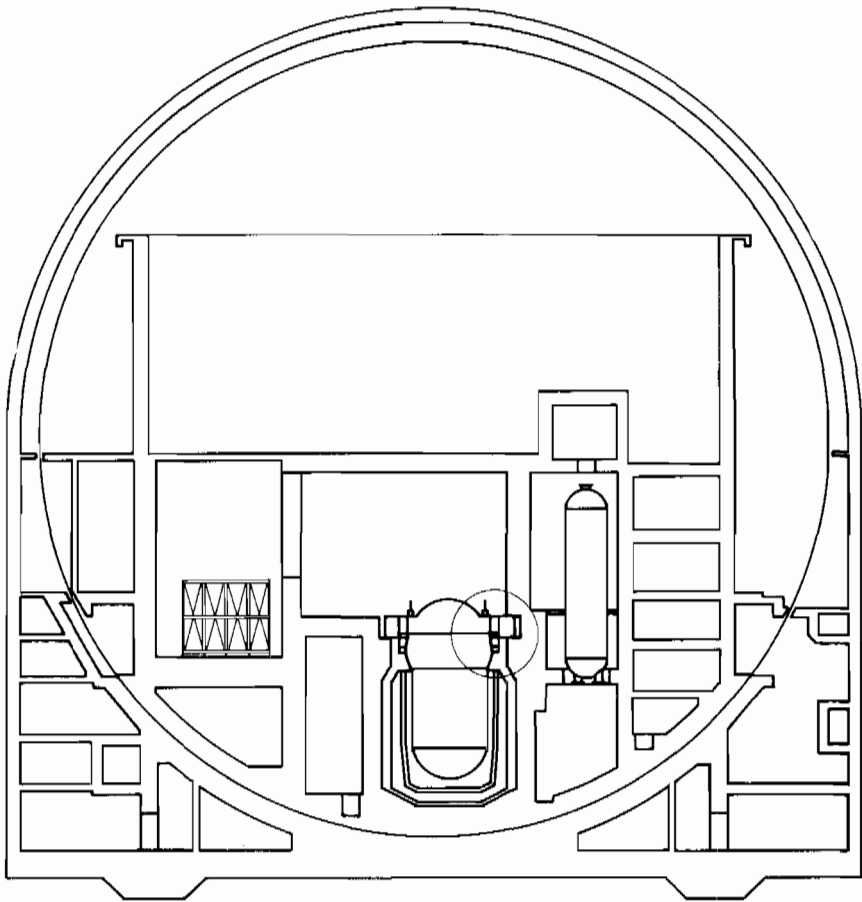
Lagerung des Reaktordruckbehälters im Ringträger
